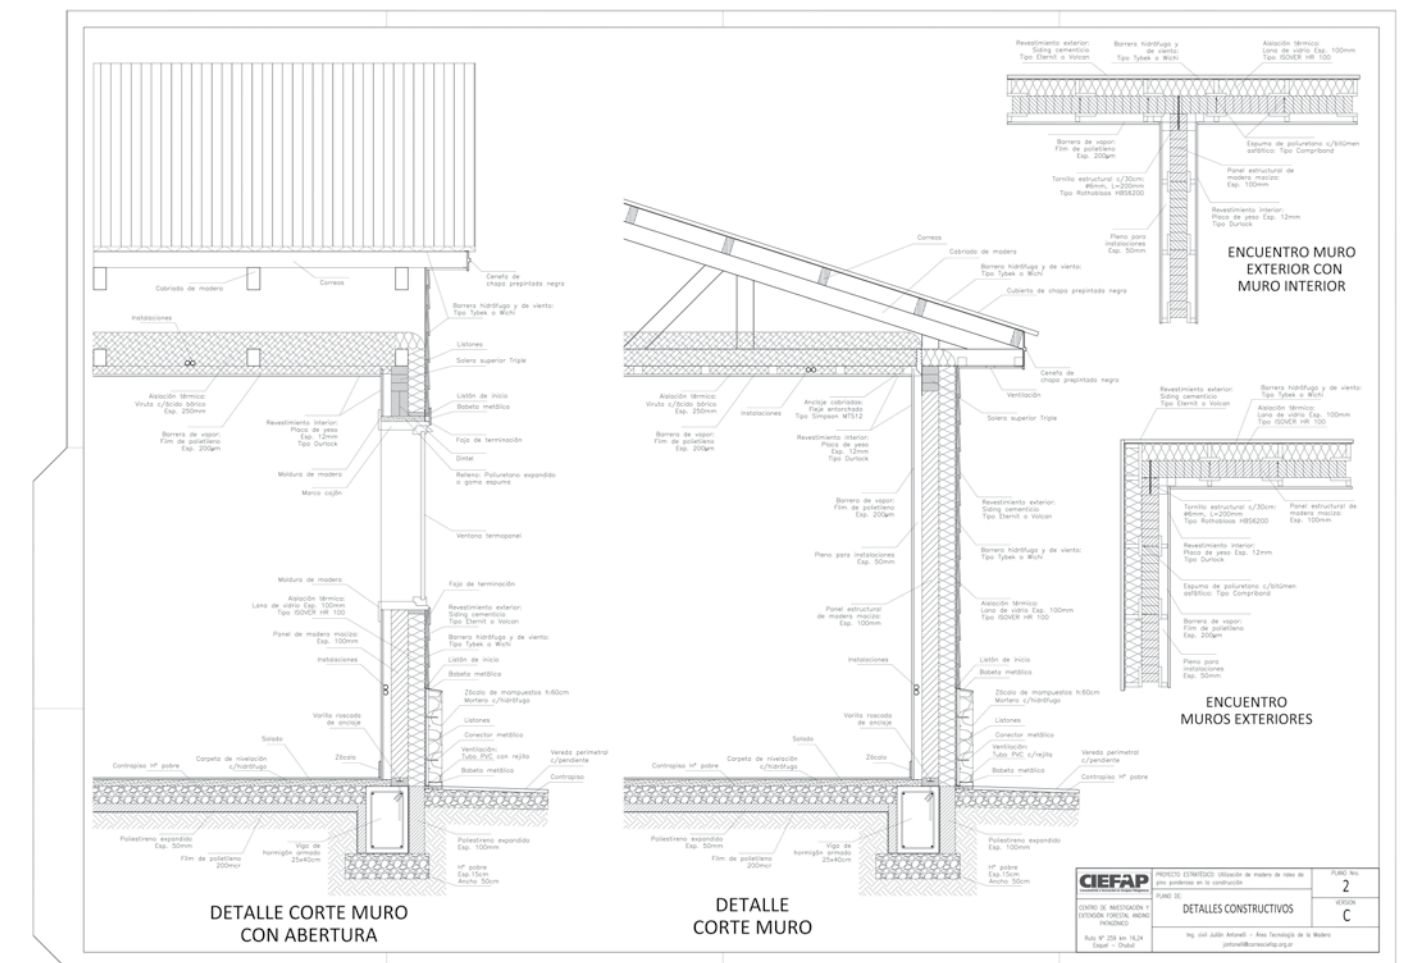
Detalle de corte de muro exterior, aislaciones y revestimientos (dos columnas).
